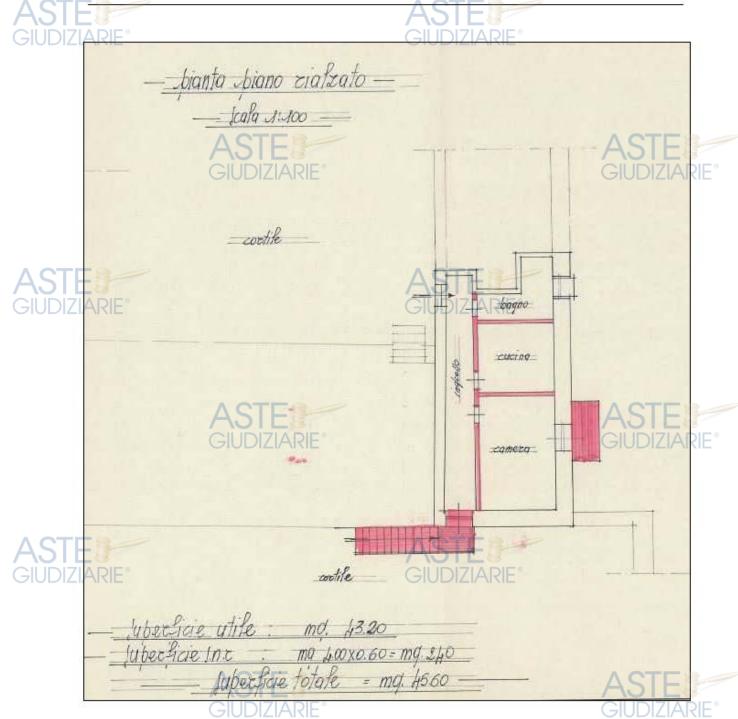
Estratto planimetria piano rialzato allegata a pratica di condono 345/87
